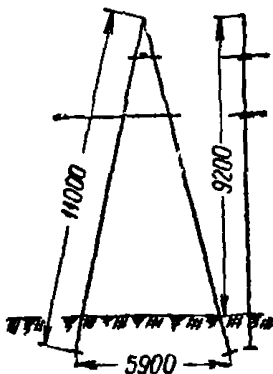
Концевая или анкерная опора с конструкцией под разъединитель
